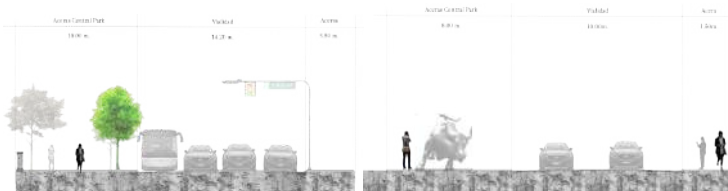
Sección vial de Fifth Avenue y Wall Street, Nueva York.
